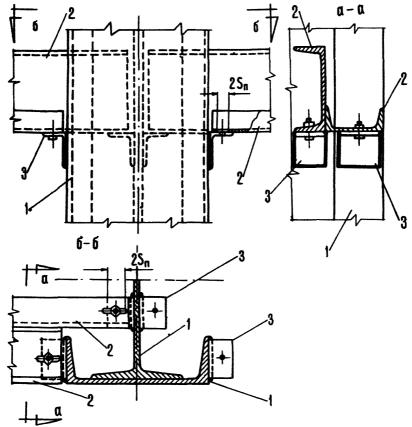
Схема устройства педатливого узла опирания ригеля фахверка на колонну каркаса:
